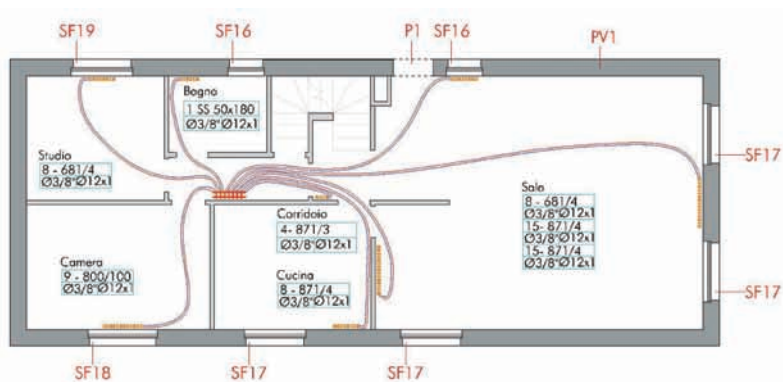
Distribuzione dell'impianto termico al piano terra
